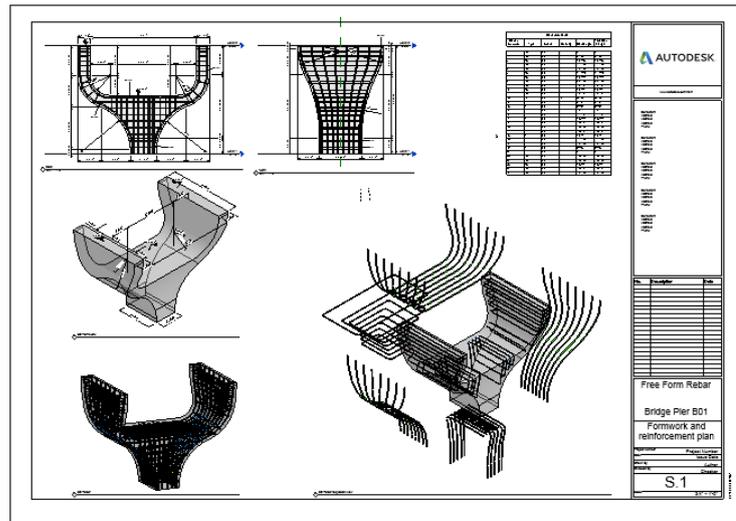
Desenhos de pormenorização de armaduras em ambiente BIM [5].
